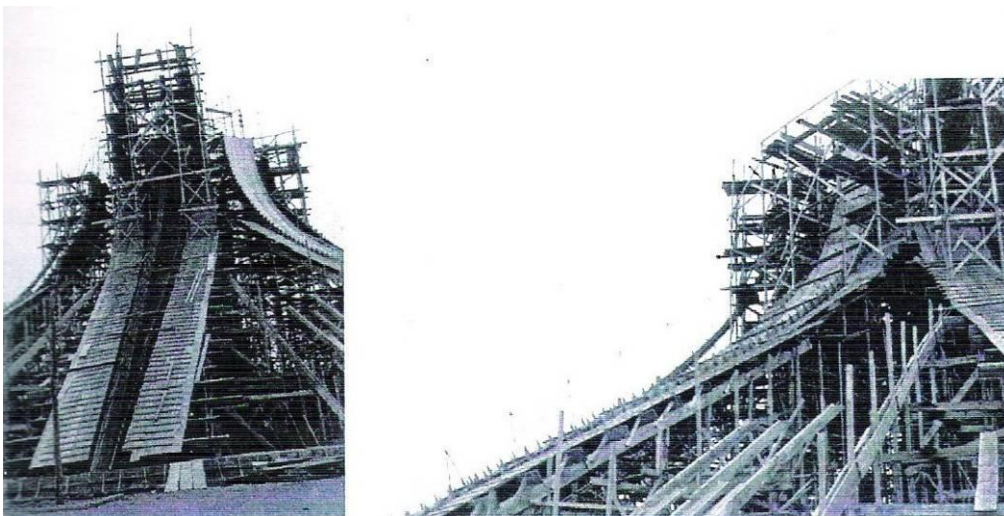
Concretagem dos Pilares da Catedral de Brasília. Fonte MAGALHÃES, 1959, p. 17.
